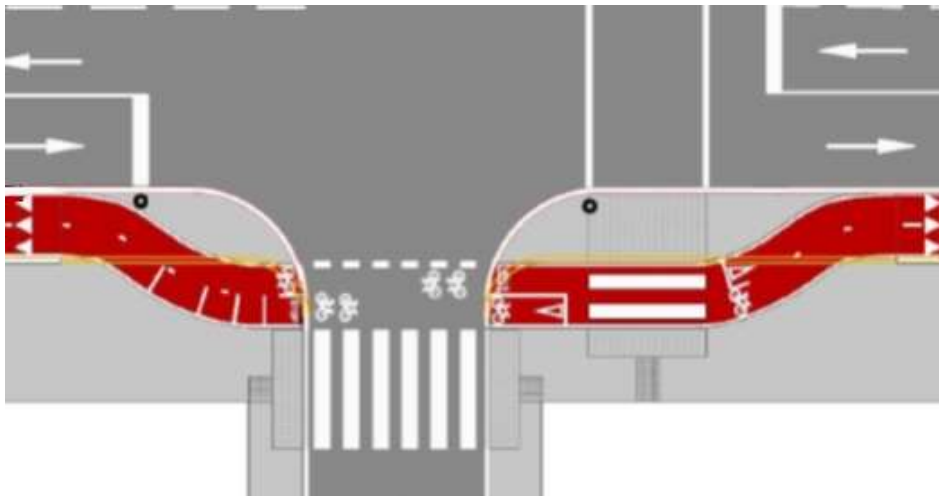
Zona de atravessamento de uma pista ciclável (CML,2014)
